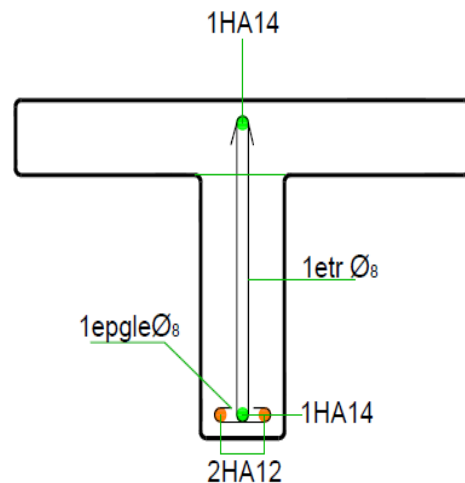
Schéma de ferrailage type 13 en travée et appui de rive
